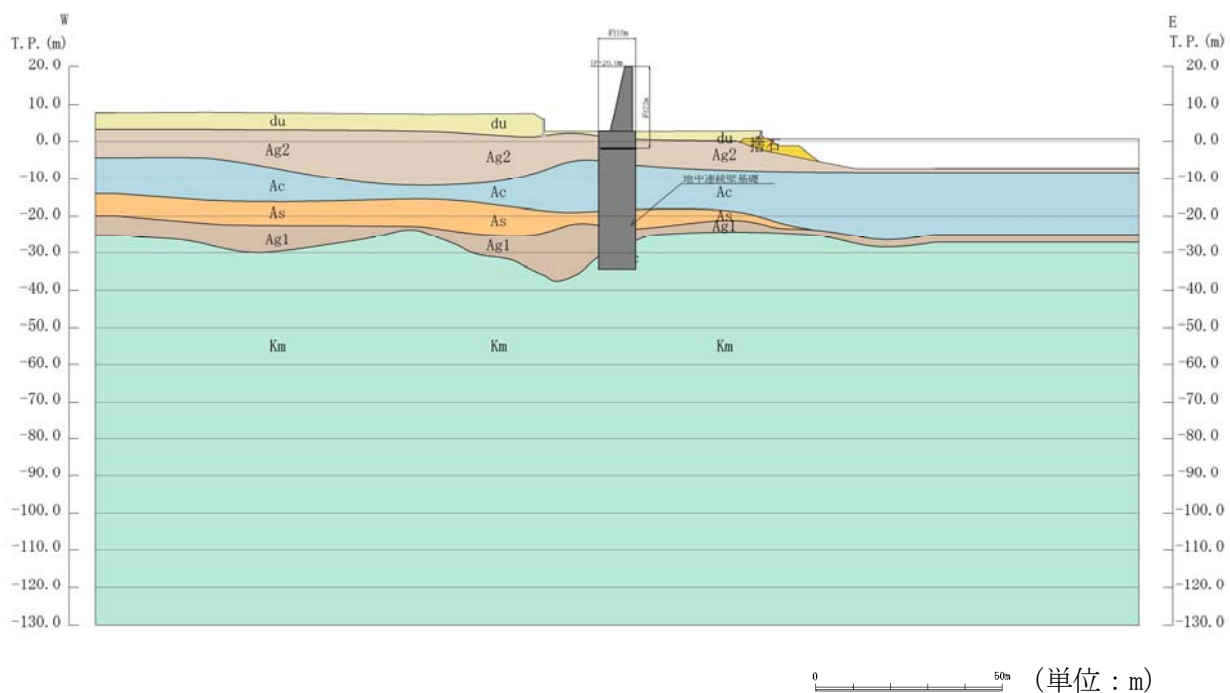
(4) 鉄筋コンクリート防潮壁 評価対象断面図 (④-④断面)
